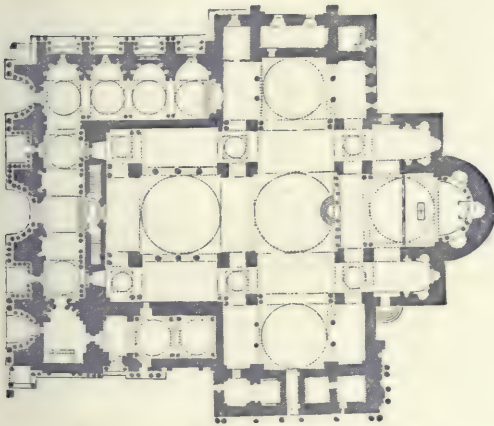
S. Marco zu Venedig. Grundriss.
